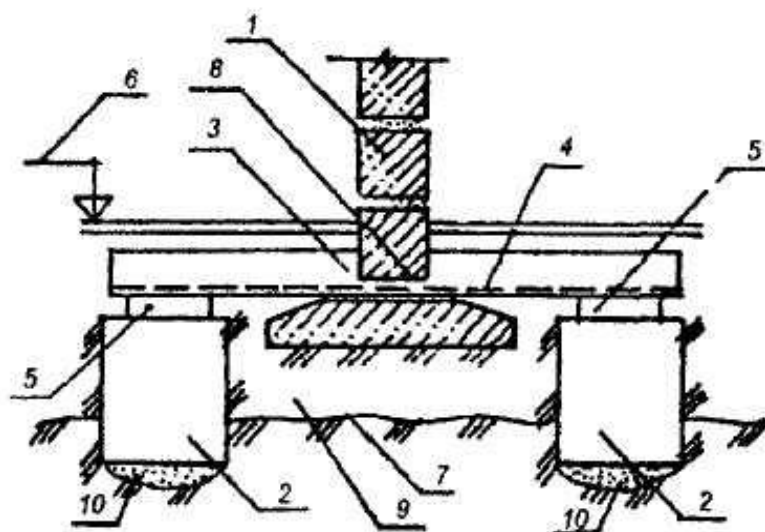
Подведение разгружающих элементов для передачи части нагрузки от стены на прочный слой основания
